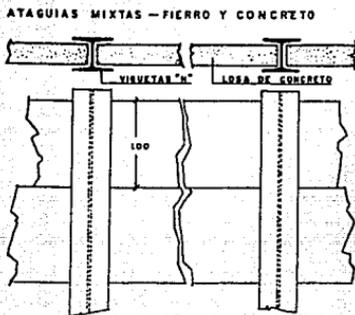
ATAGUIA MIXTA, ACERO Y CONCRETO
